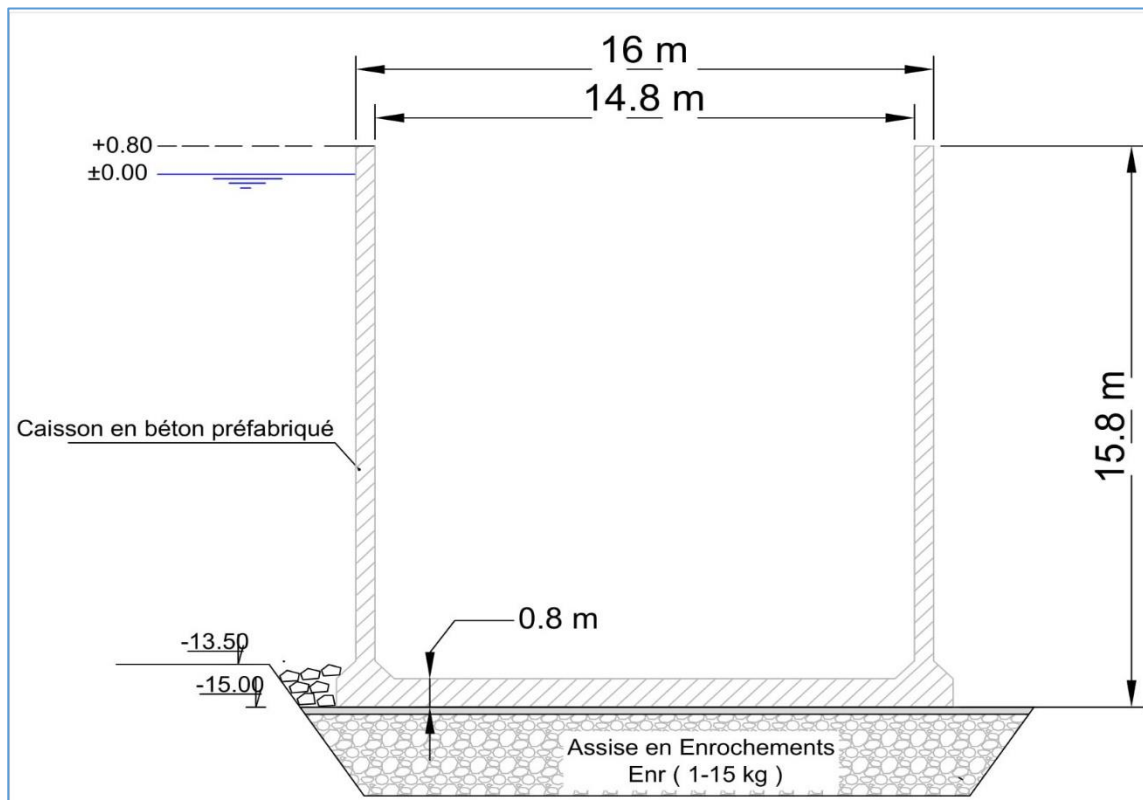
coupe transversale de la variante 2 (quai en caisson)
